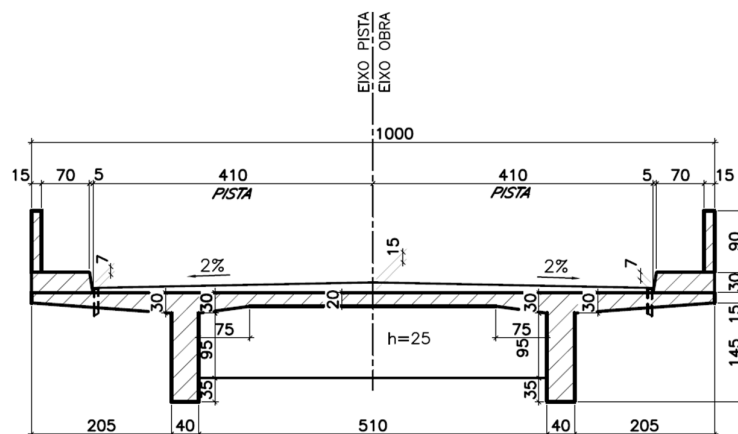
Corte transversal no meio de vão da ponte existente (cotas em cm).
